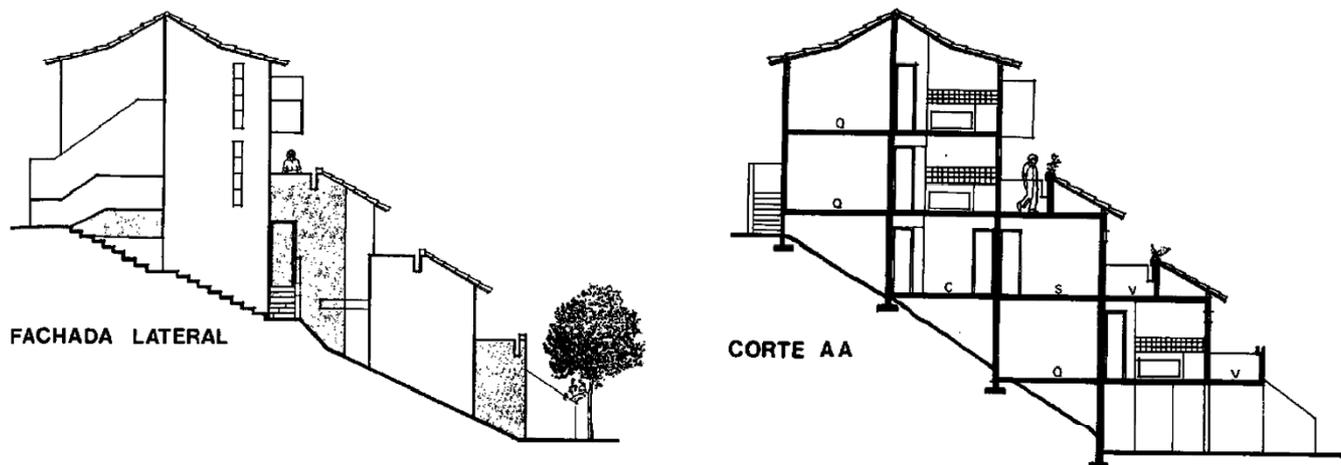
Fachada lateral e corte transversal de unidades projetadas para encostas. Fonte: ANDRADE, M.R. et SOUZA, M.A.A. (1981)². Manual de projeto de habitação popular. Parâmetros para elaboração e avaliação. (s/pág.).
